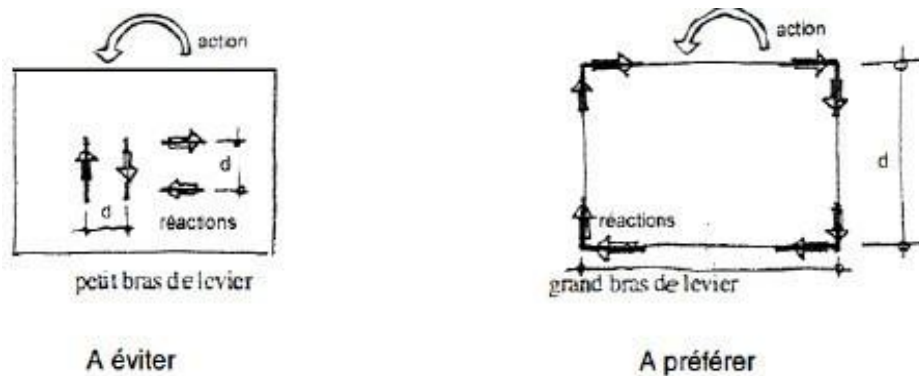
Distance entre les éléments de contreventement. Une grande distance entre les éléments parallèles favorise la résistance de la structure à la torsion grâce à un bras de levier important dans le plan horizontal [13].
